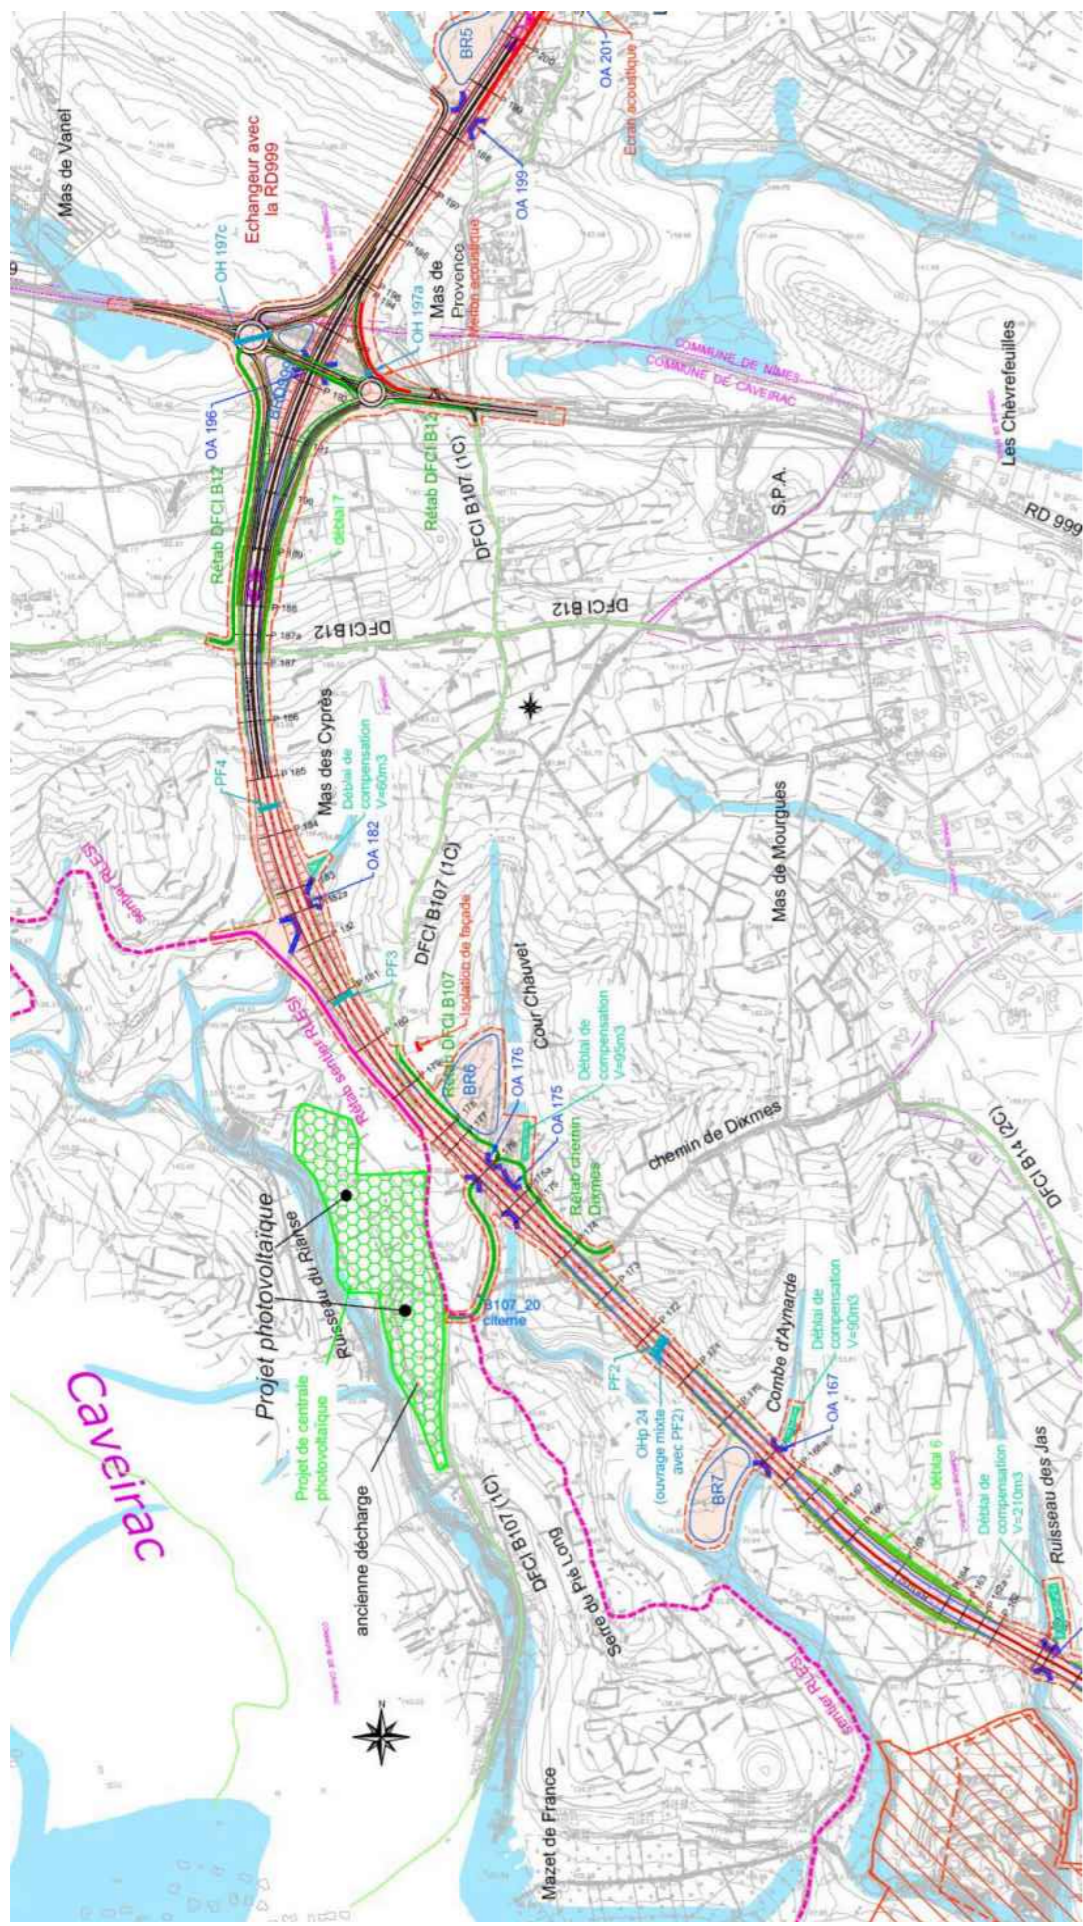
PLAN DE MASSE DU PROJET (SOURCE : PRÉSENTS, JUIN 2021)
